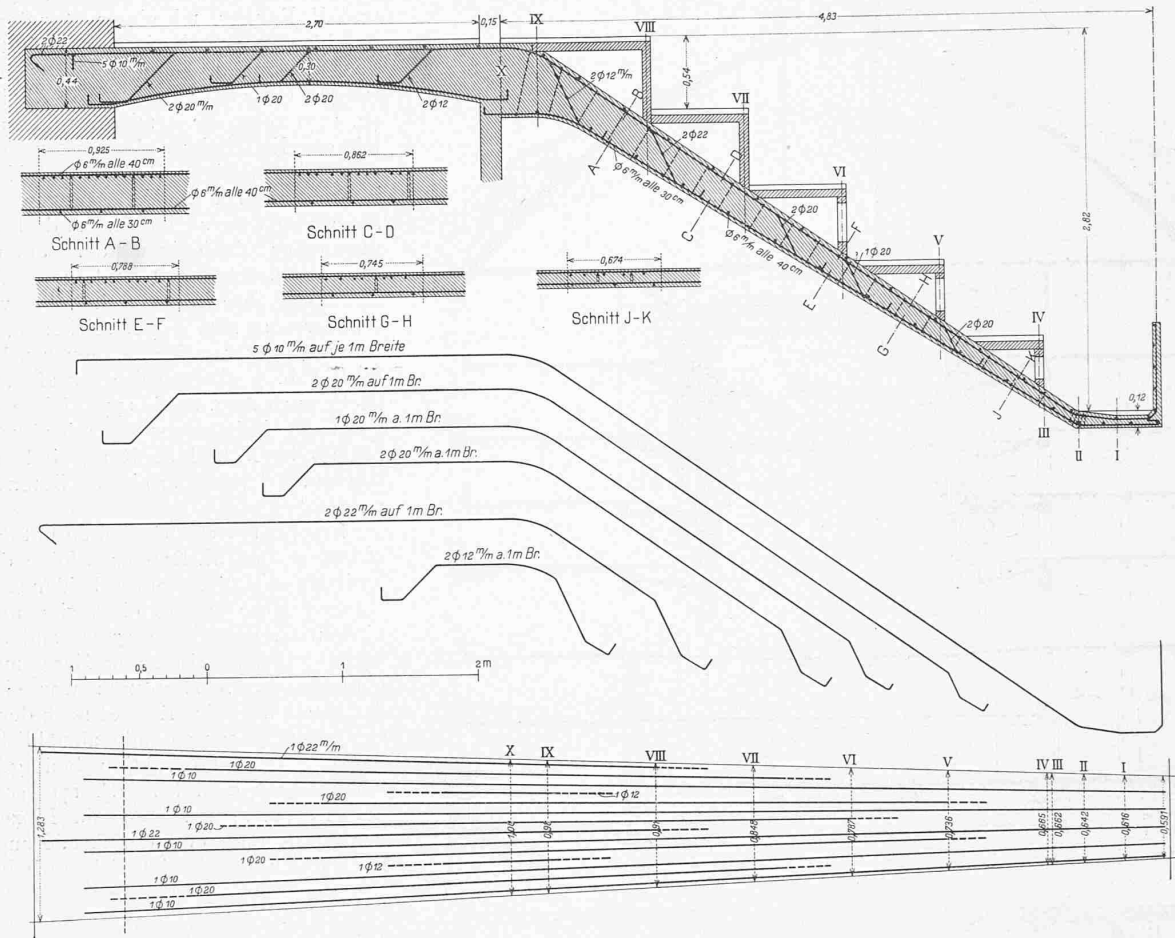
Armierungsplan des III. Ranges. — Masstab 1 : 50.
